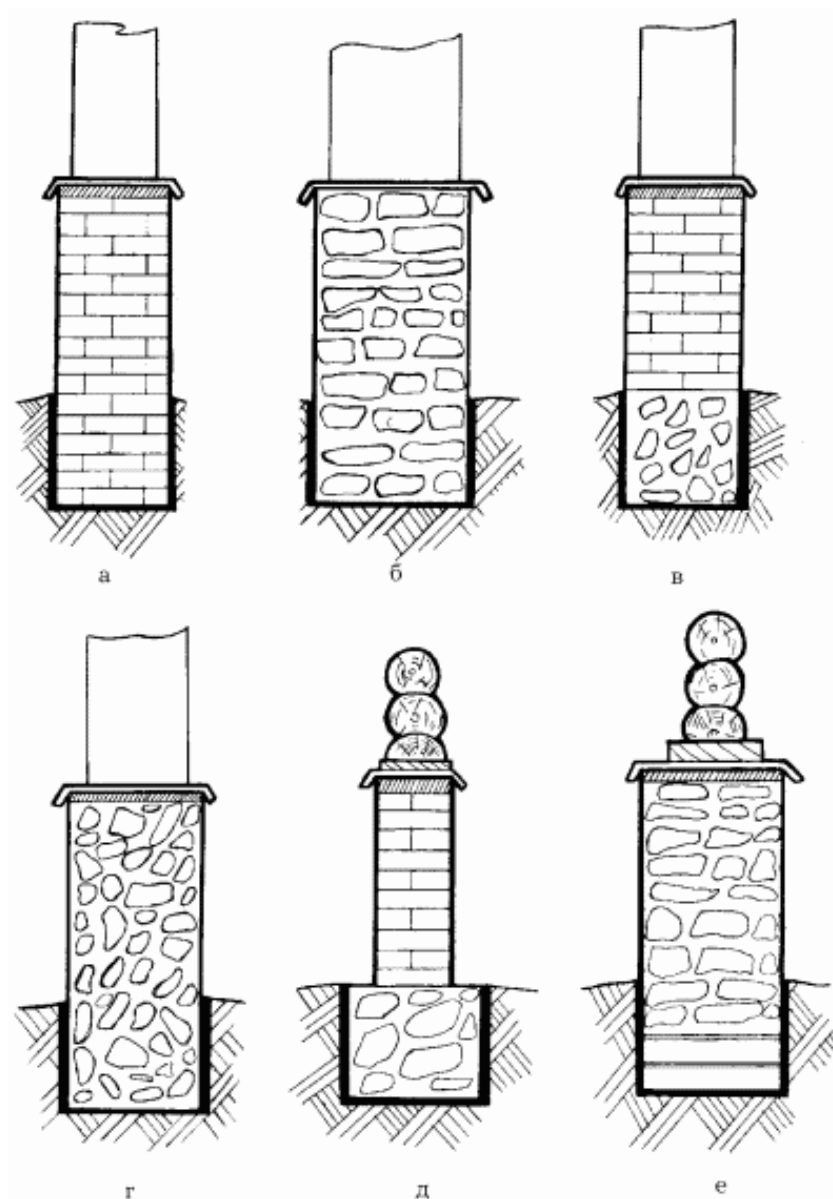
Фундаменты, сделанные из различных материалов: а – кирпичный; б – бутовый; в – кирпичный с бутобетоном; г – бутобетонный; д – кирпичный с бутом; е – бутовый на песчаной подушке.
